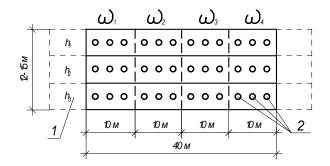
Схема площадки для опытного уплотнения грунта: I – площадка для разворотов катка; 2 – места отбора проб грунта
